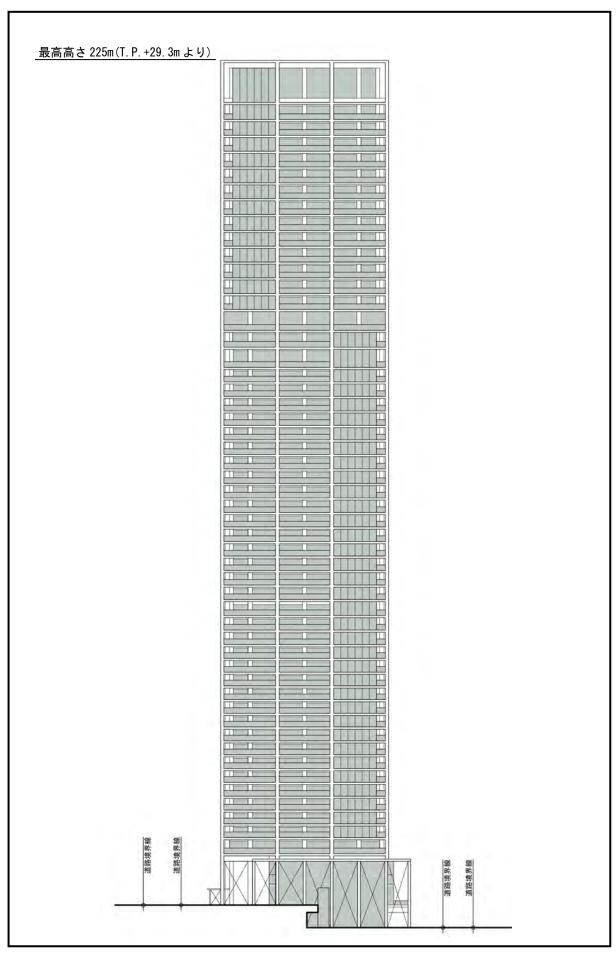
(5) 立面図 (南立面図 S=1:1,000) 【変更前】
